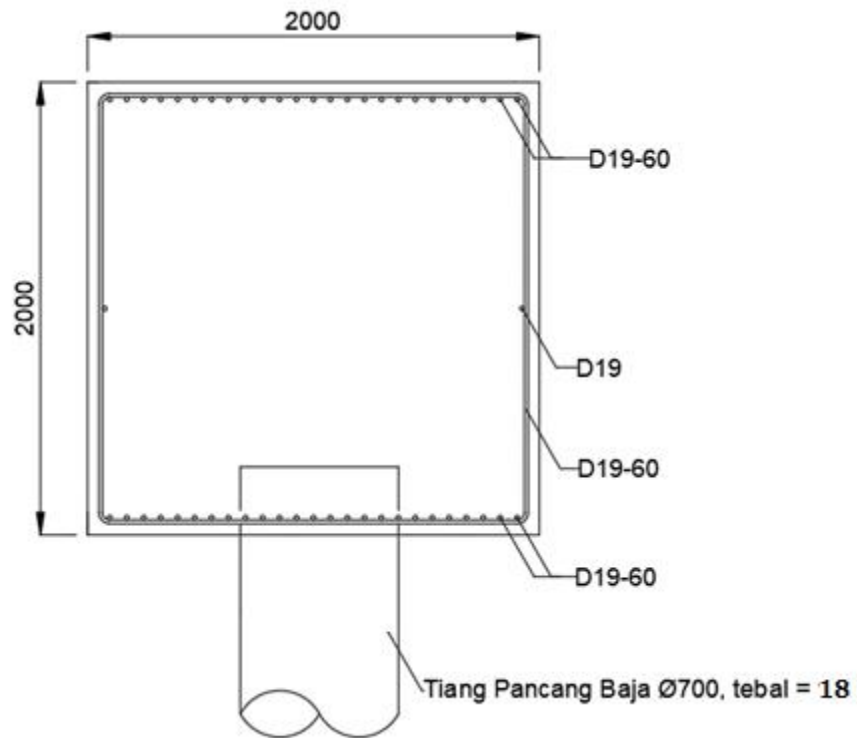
Desain Penulangan Balok Tipe-4 (Balok Kantilever)Keterangan : Satuan Dalam mm
